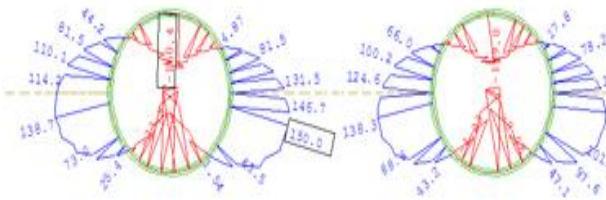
Эпюры моментов, возникающие в конструкции железобетонной обделки на стадии завершения строительства тоннеля
